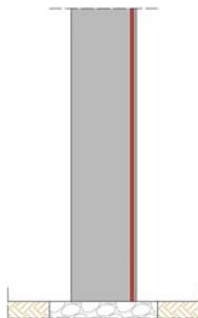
Refuerzo de pilar mediante encamisado metálico completo. Fuente propia.
